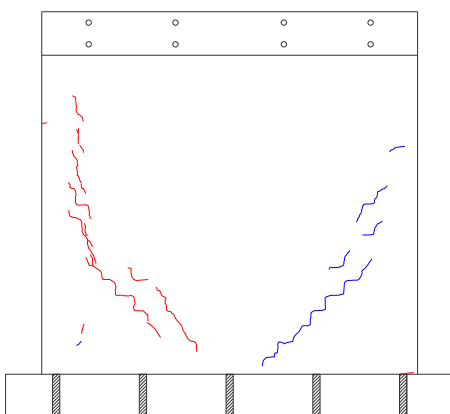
Agrietamiento de muro de albañilería confinada con ladrillos sólido artesanal en la distorsión 1/1500.
